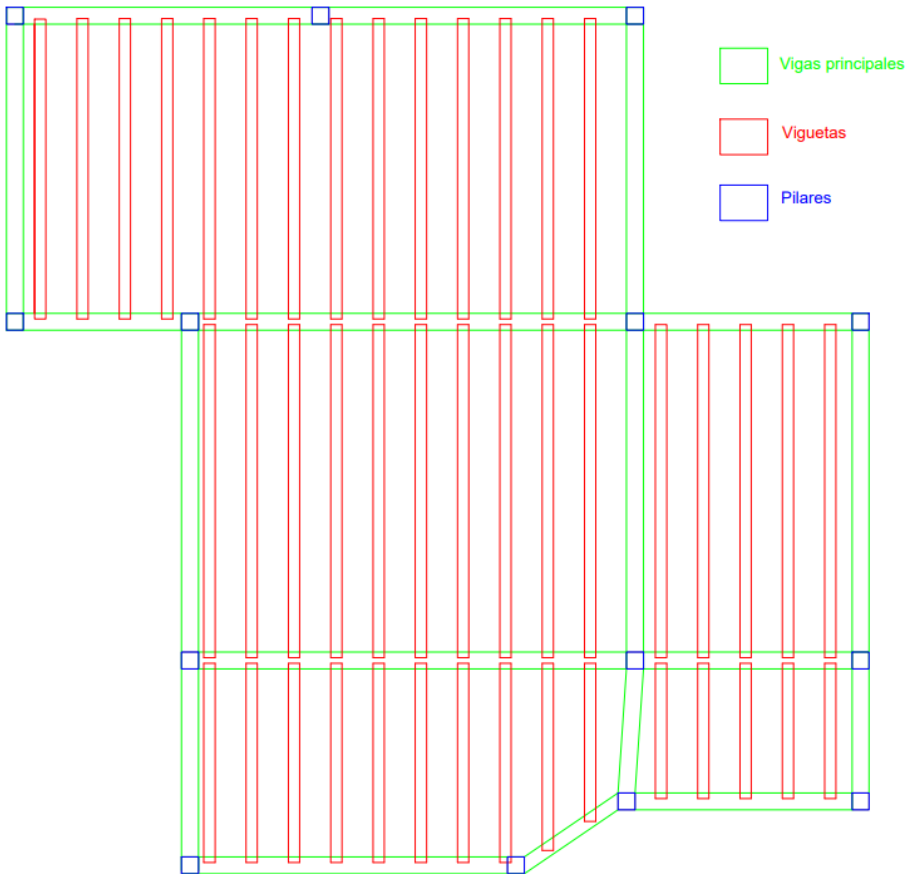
Disposición en planta de vigas, viguetas y pilares. Fuente propia
